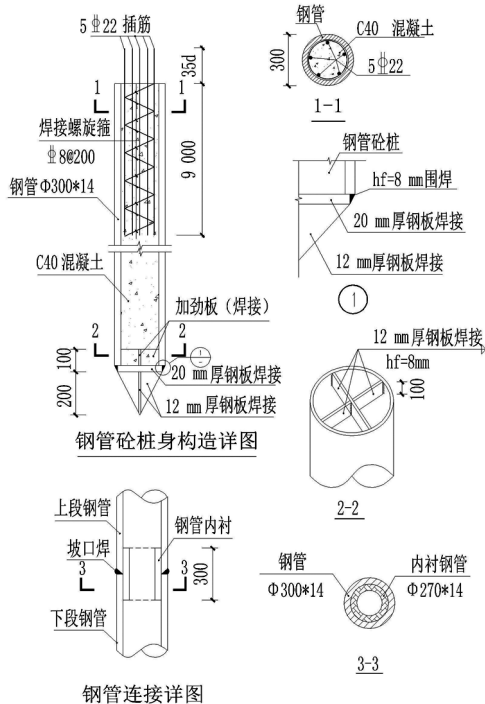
钢管混凝土桩桩身构造大样图(单位:mm)
